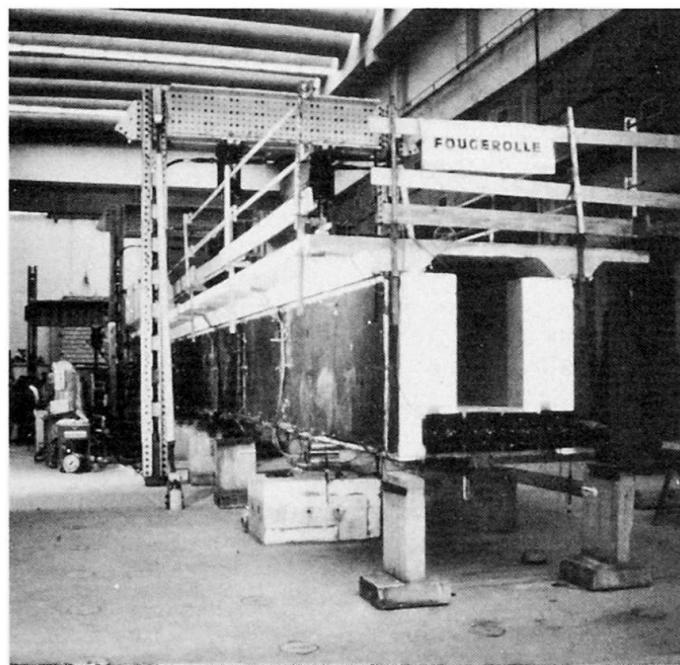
Maquette d'essai de Saint-Rémy-les-Chevreuse.
